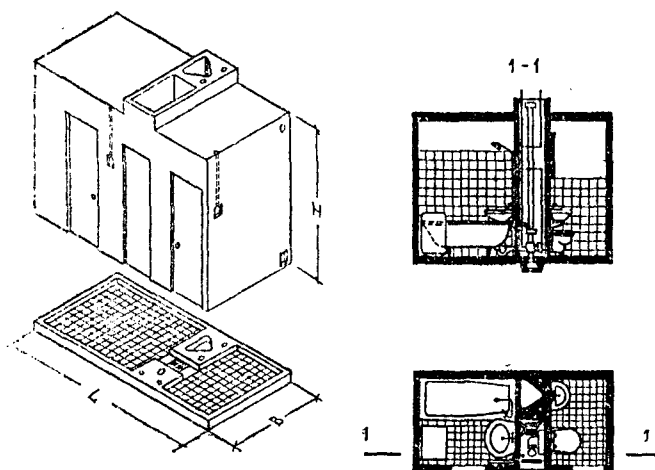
Санитарная кабина, совмещенная с вентиляционной шахтой
